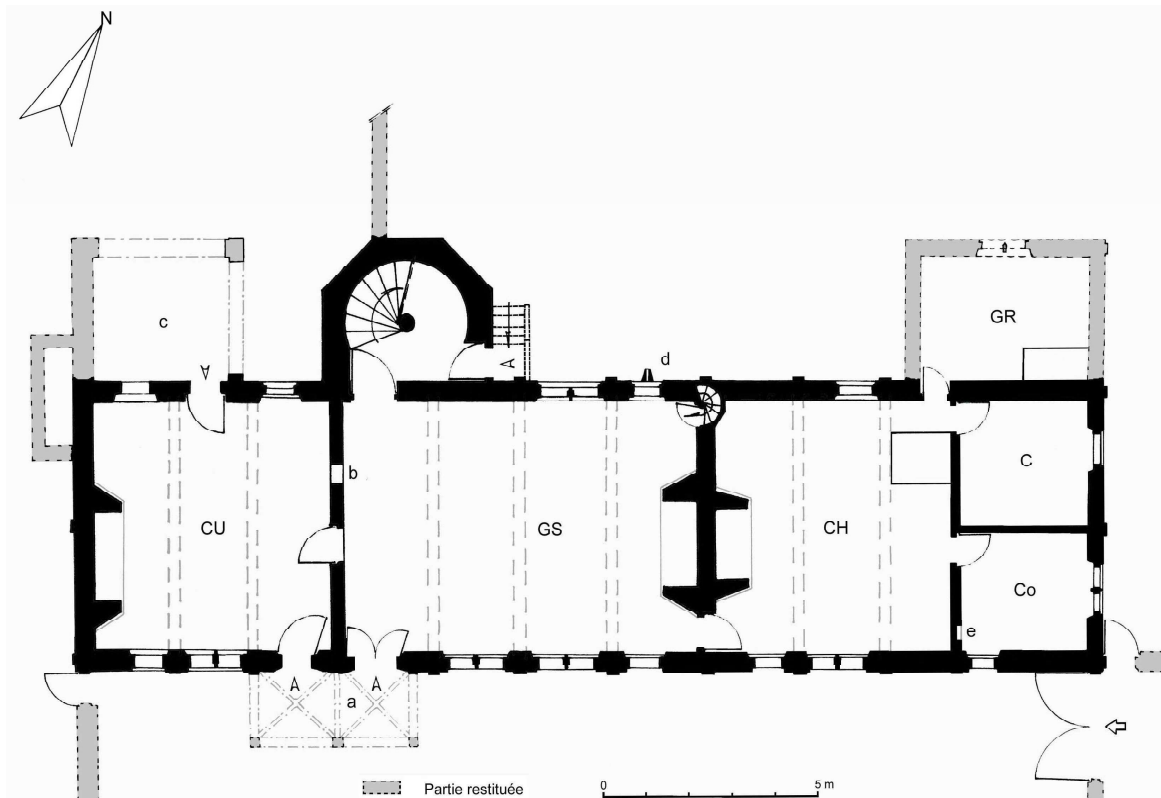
Sénitot. Plan restitué du rez-de-chaussée entre 1528 et 1536.
